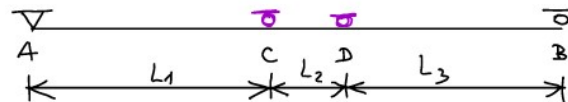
Расчетная схема многопролетной балки для диска перекрытия с жесткими стенами
